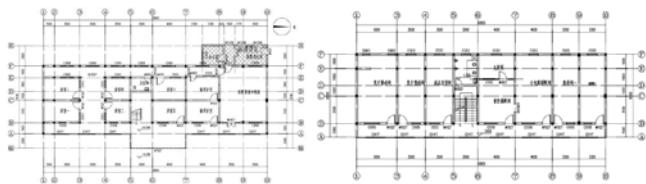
一层平面图(填充墙体为后封堵) 图2 二层平面图(填充墙体为后封堵)
